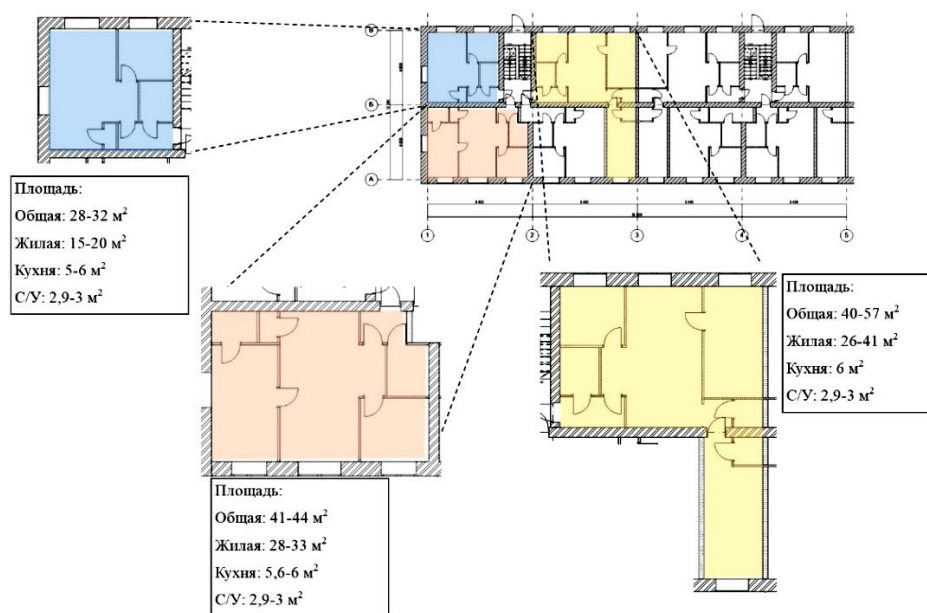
План этажа и габариты помещений в здании типовой застройки 1-447
